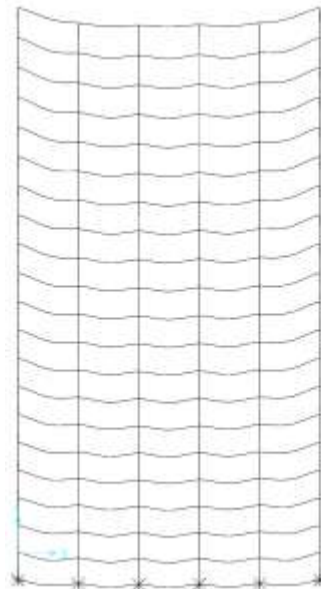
Deformadas – Corte Longitudinal passando pela Viga V7 – Caso 2 – Sem o vento
